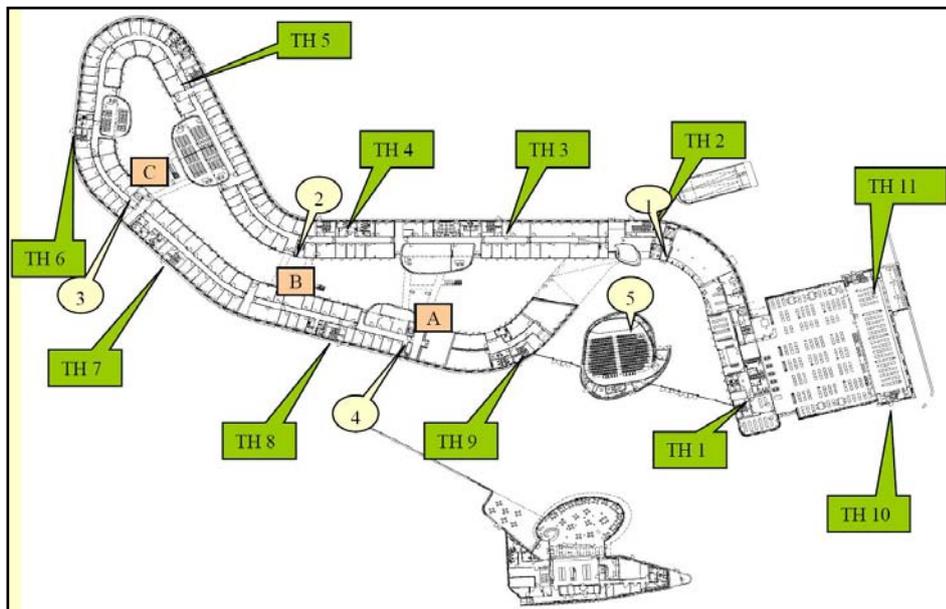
UBA – Grundriss Erdgeschoss [Quelle: Müller]
